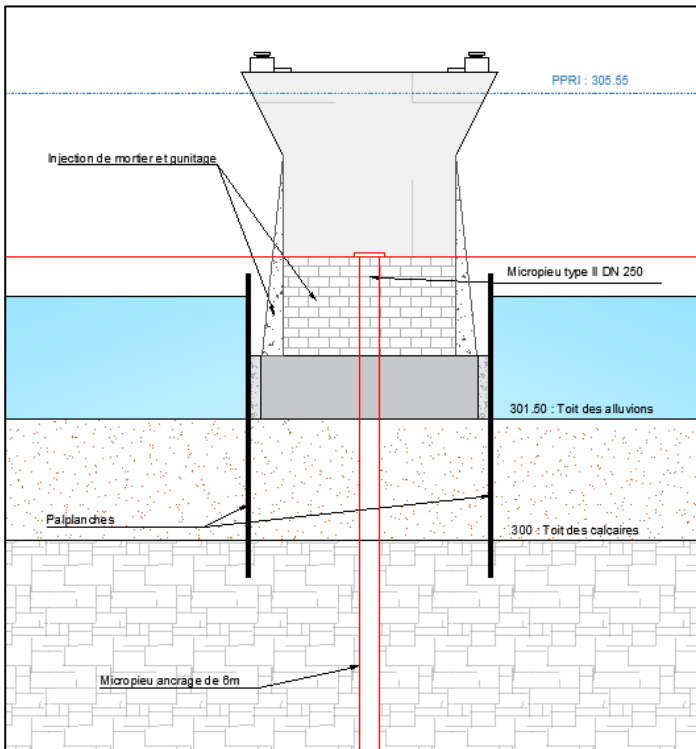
Coupe d'une des piles intermédiaires à conforter
